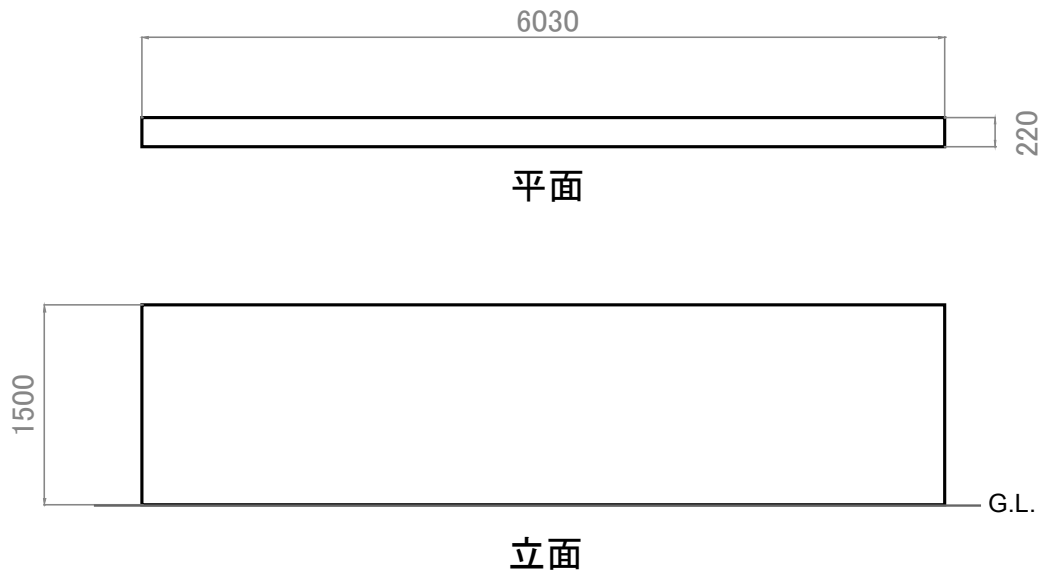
ST 冷蔵前の RC 塀 (西) 立面・平面図 (単位: mm)
